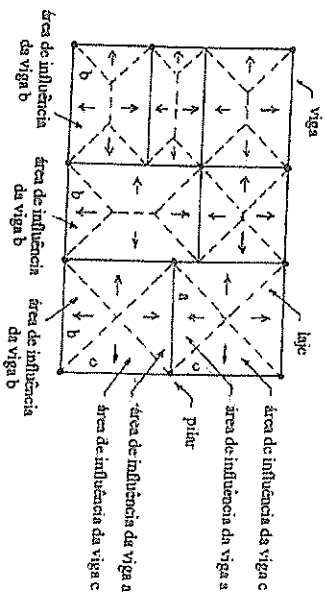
Esquema da estrutura de um pavimento e as áreas de influência das vigas
